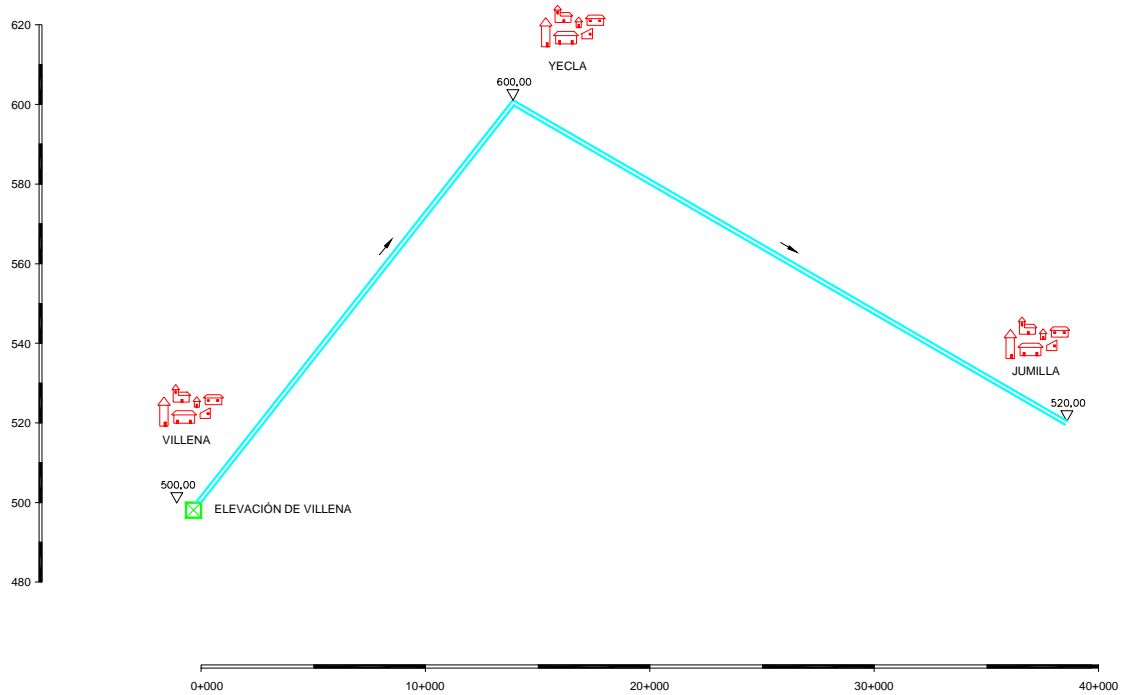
Conducción Villena-Altiplano. Esquema en alzado
